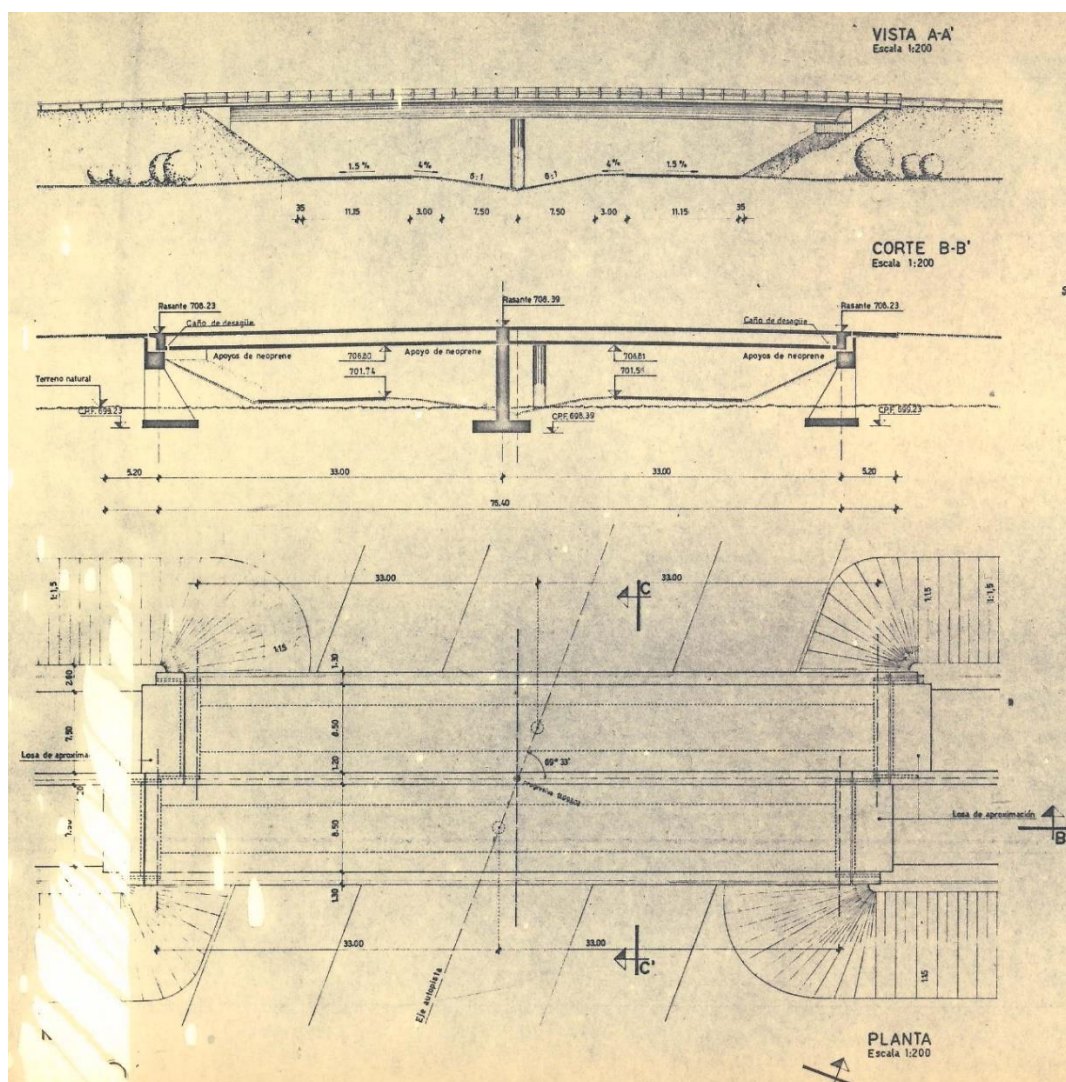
Vista, Corte y Planta en Puente típico de la clase VCH-CTM.
